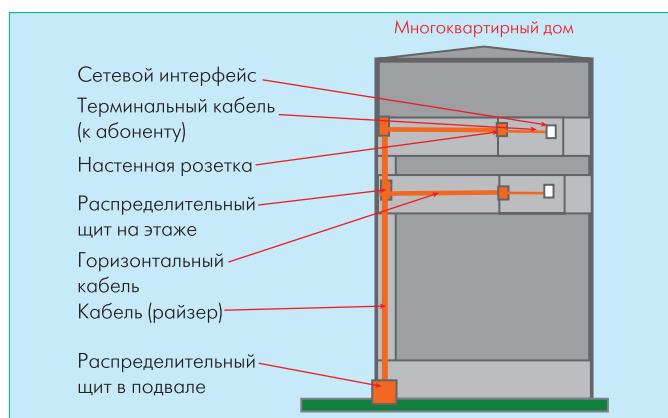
Схема кабельной проводки и расположения оборудования в многоквартирном доме
